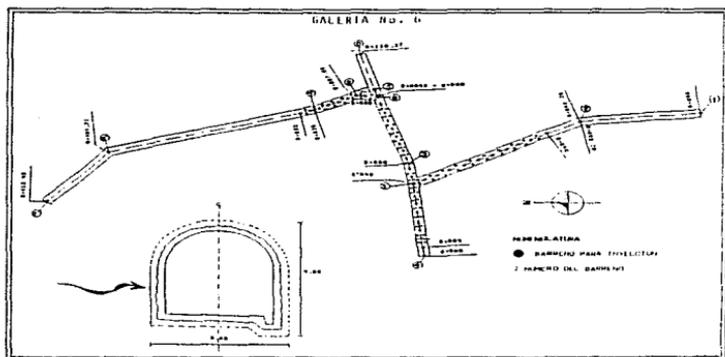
Inyección de contacto concreto - roca galería No 6
